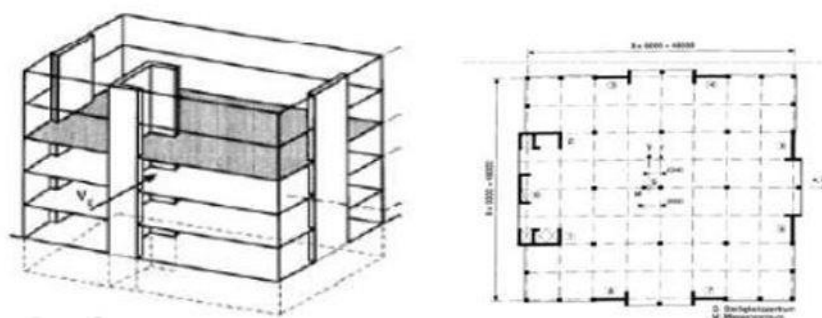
Noyaux, parois - haute rigidité et stabilité
